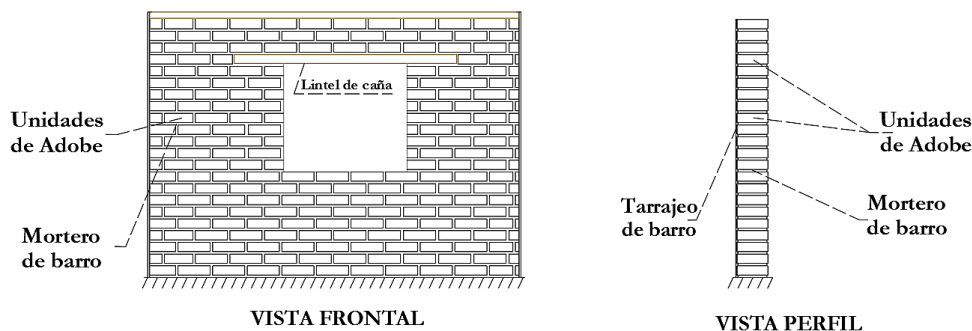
Estructura típica de la Mampostería de Adobe (Frontal y Perfil)
